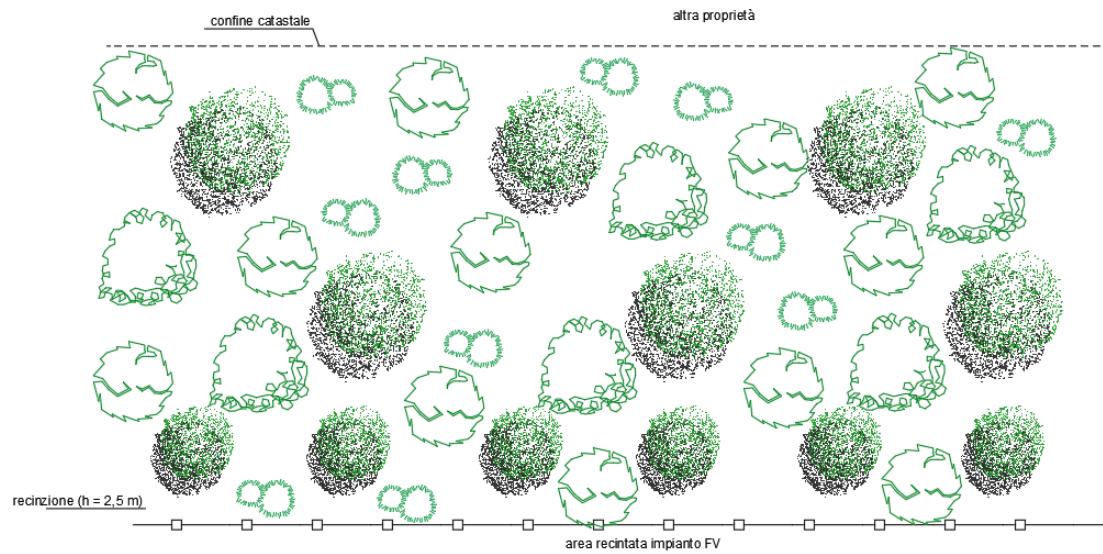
Siepe polispecifica (planimetria di progetto)
